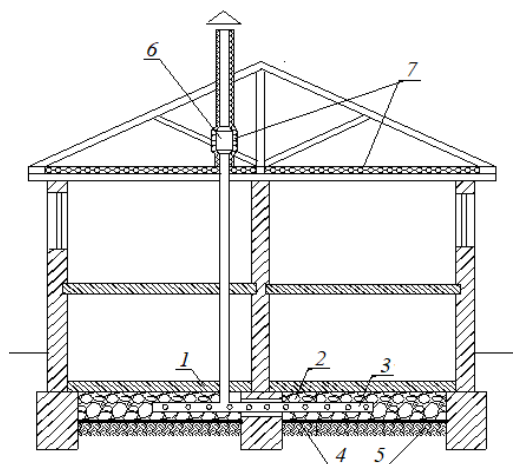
Активная система создания депрессии в подпольном пространстве: 1 — бетонная плита; 2 — щебень; 3 — перфорированная труба; 4 — фильтрующий слой; 5 — уплотненный грунт; 6 — вытяжной вентилятор; 7 — теплоизоляция
